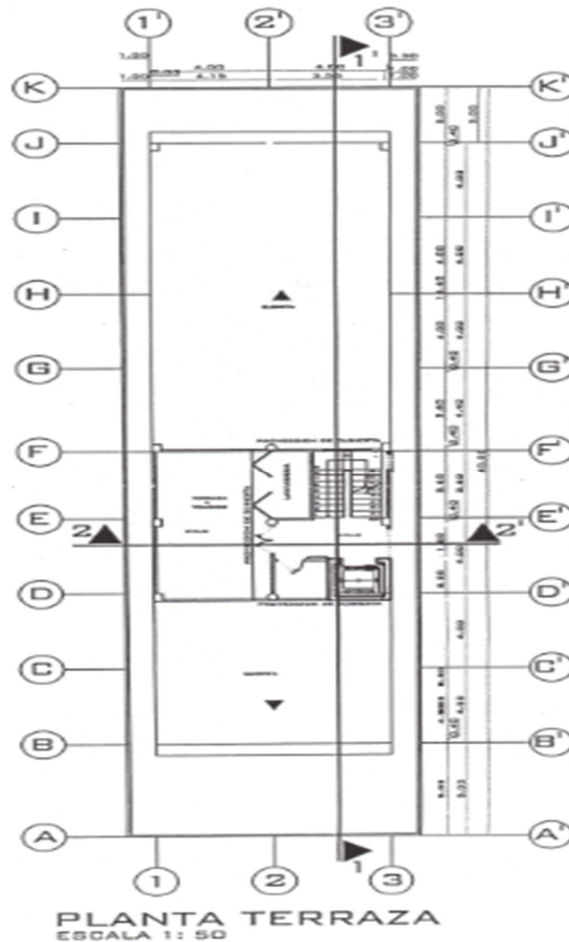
Edificio: Planta Terraza. Fuente: SOLCA
